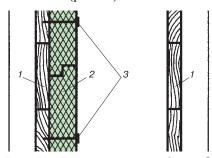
Оптимальная теплоизоляция мостиков холода в области опоры перекрытия
